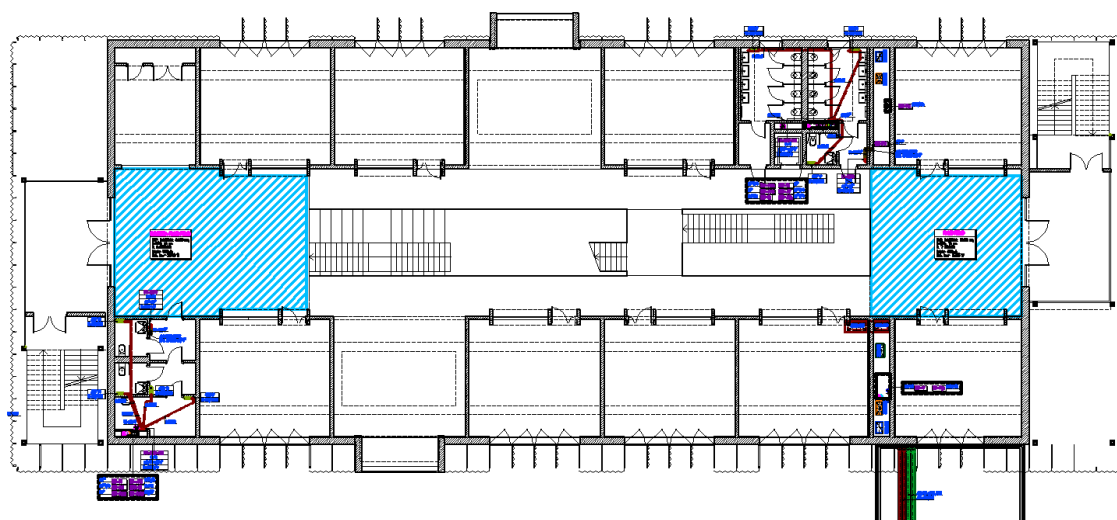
Pianta piano primo palestra: VMC in progetto
